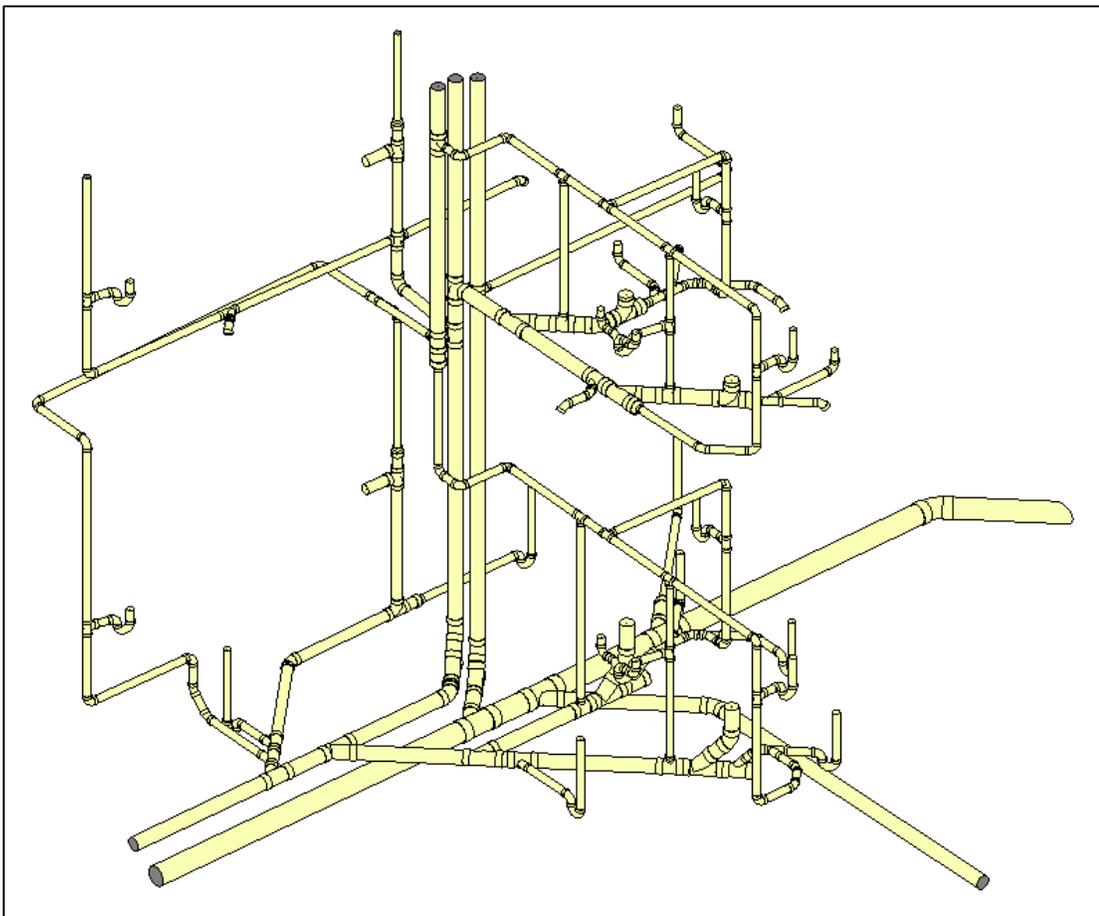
Tuberías de A.N. y drenaje de P1 y P.B.
